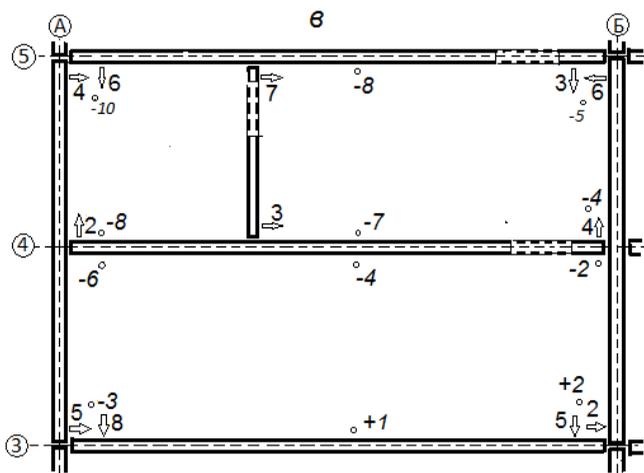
Исполнительная схема плано-высотного положения конструкций панельного здания на уровне поверхности межэтажного перекрытия (план): стрелками показаны направления смещений панелей по низу; цифрами со знаком + или – даны отклонения верха панелей перекрытия по высоте (в миллиметрах)
